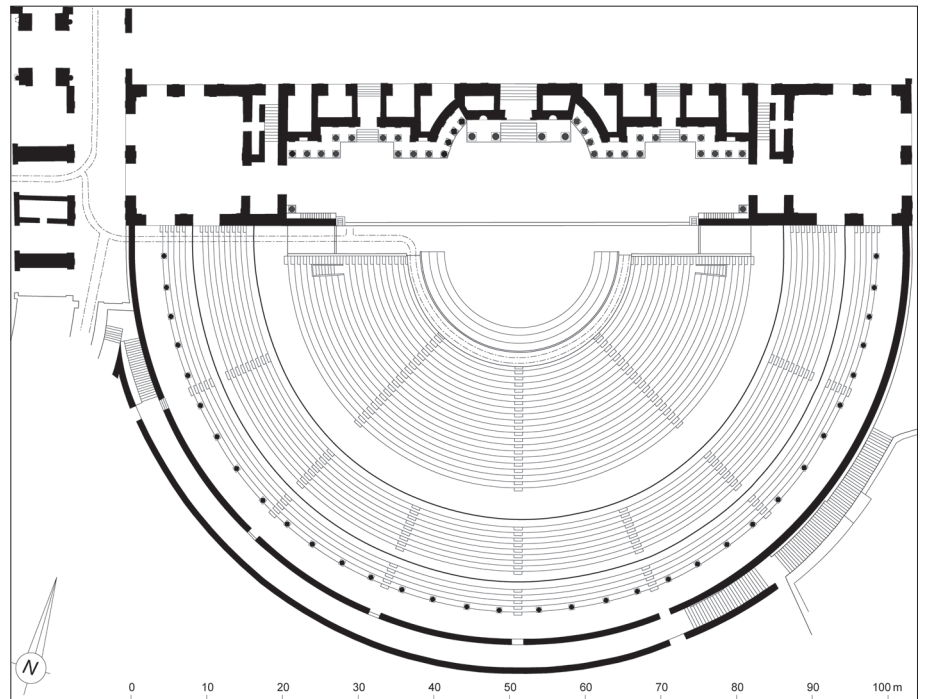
Plan général du théâtre restitué (A. Badie). 1/1000
